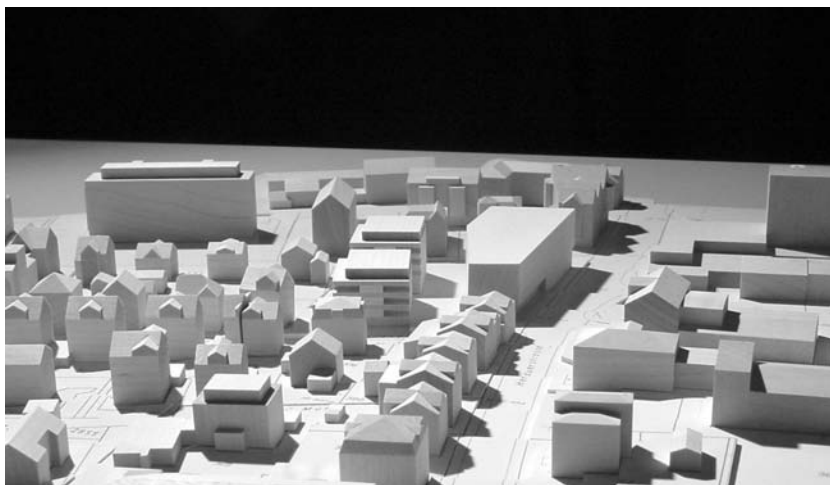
Modellansicht Süd mit bestehenden Bauten in der Umgebung
